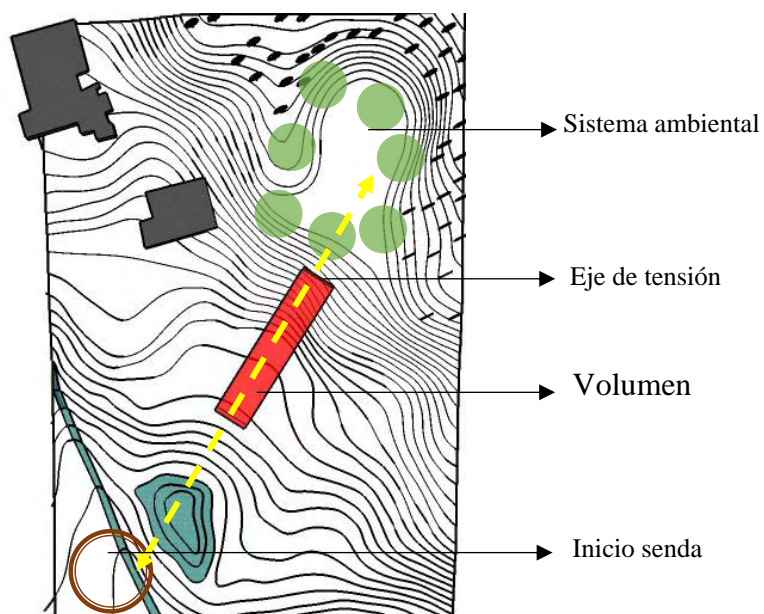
esquema 1 en planta. Fuente: Elaboración propia
